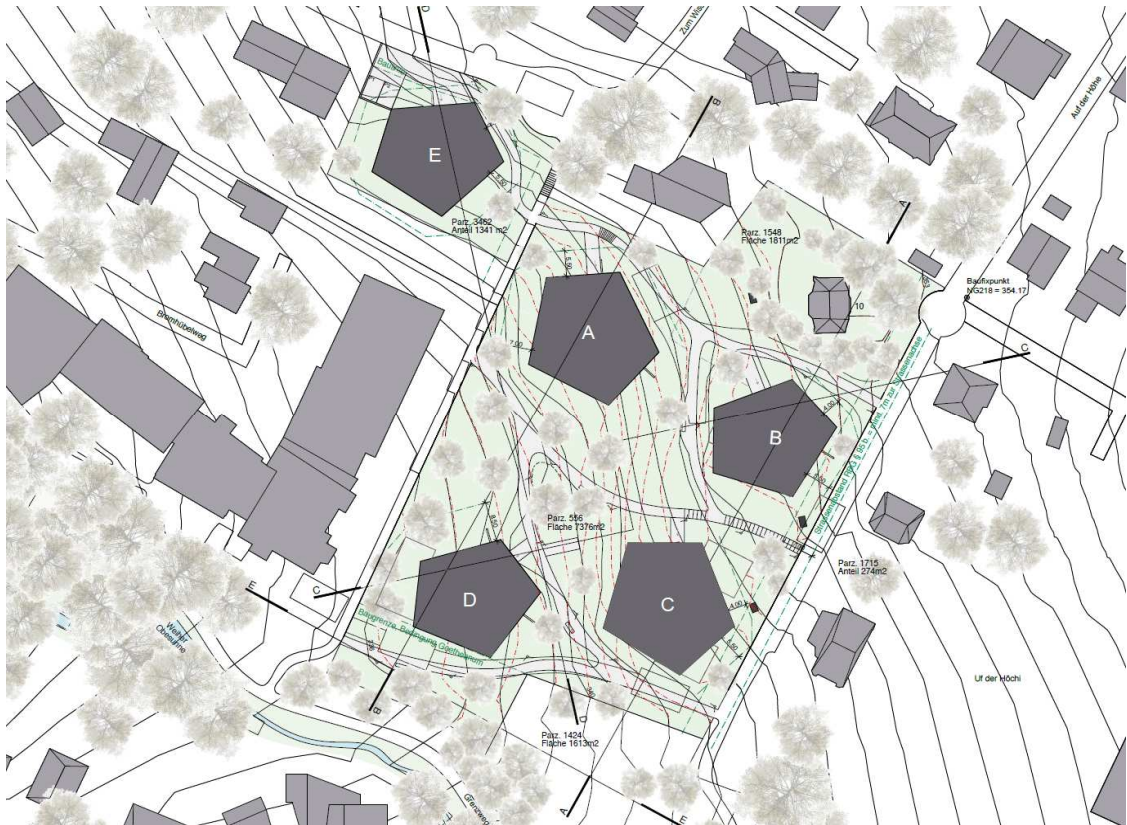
Bebauungskonzept (TrinklerStulaAchille Architekten AG, Juni 2016)
